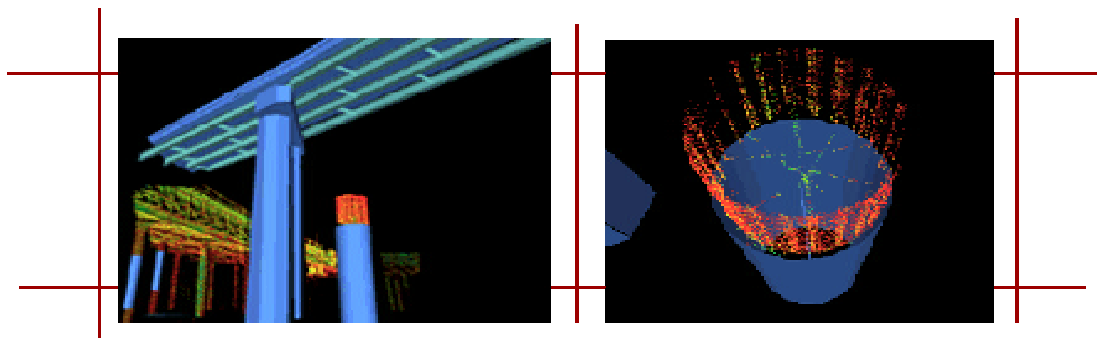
D-Modell einer Brücke (linkes Bild); Detailansicht eines Brückenpfeilers (rechtes Bild) aufgebaut aus der 3D-Punktwolke
